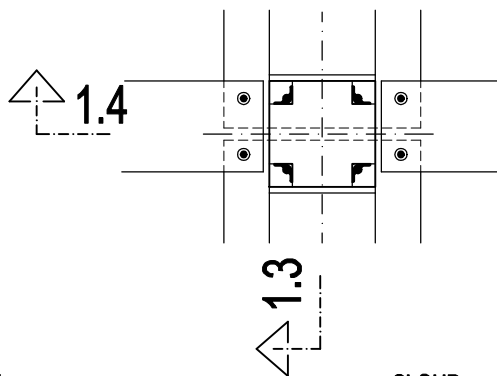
SPOJENÍ PRŮVLAKU SE SLOUPEM A ZTUŽIDLEM (VNITŘNÍ)
